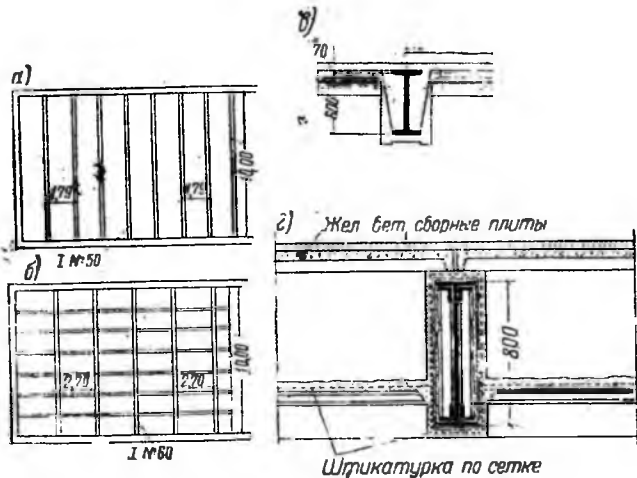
Конструкция междуэтажных перекрытий малых зал
